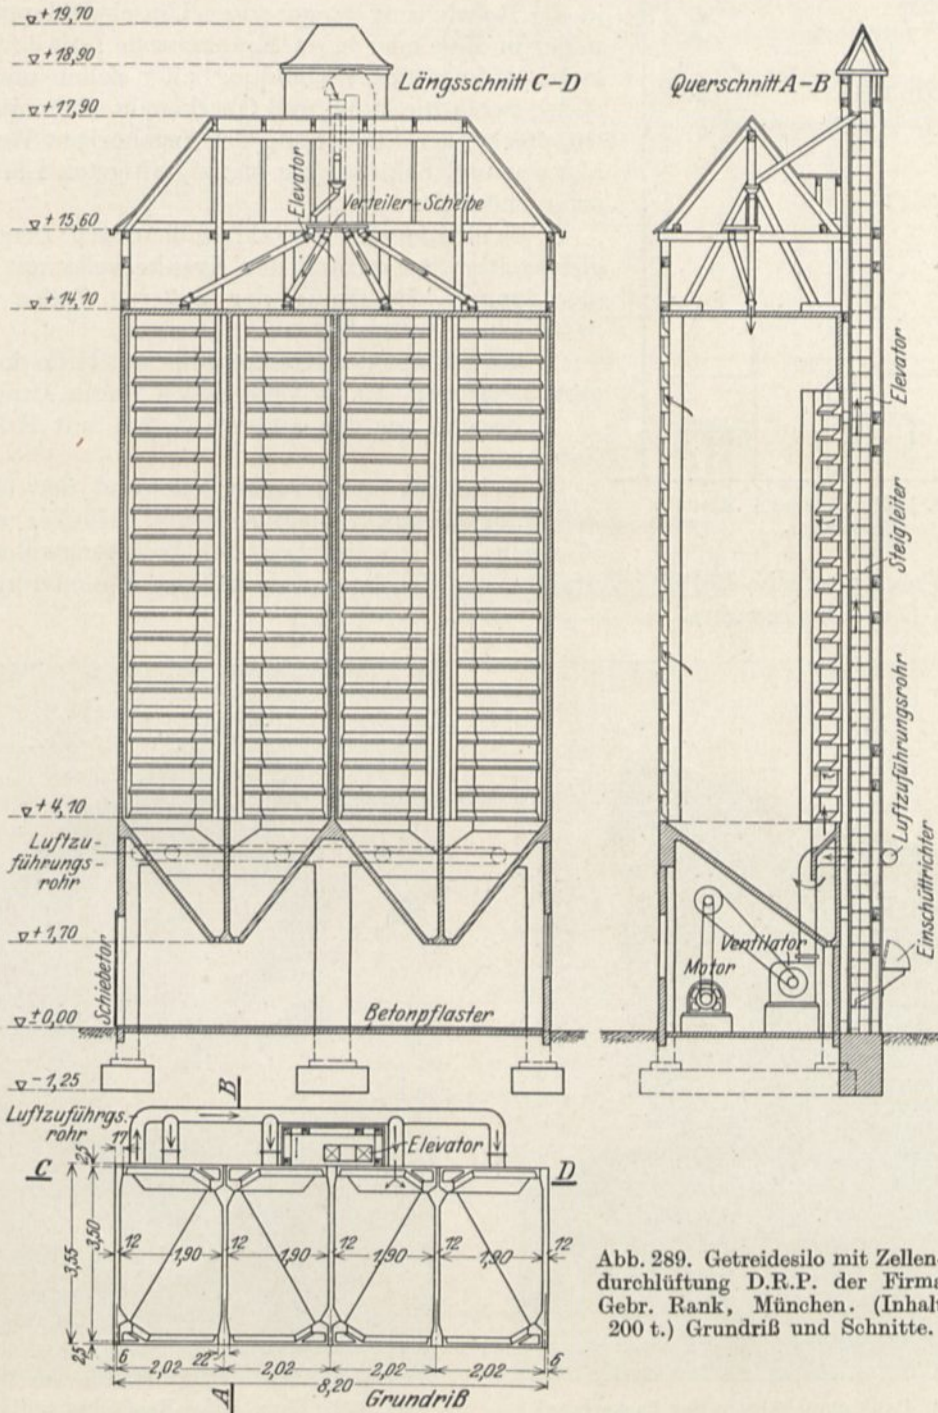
Getreidesilo mit Zellen-durchlüftung D.R.P. der Firma Gebr. Rank, München. (Inhalt 200 t.) Grundriß und Schnitt.
